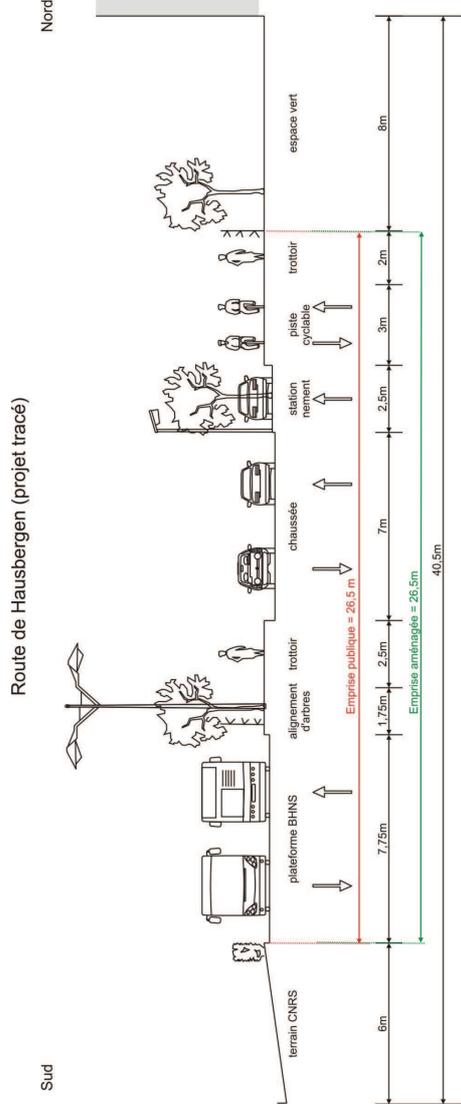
Situation projetée (coupe 27) route de Hausbergen
